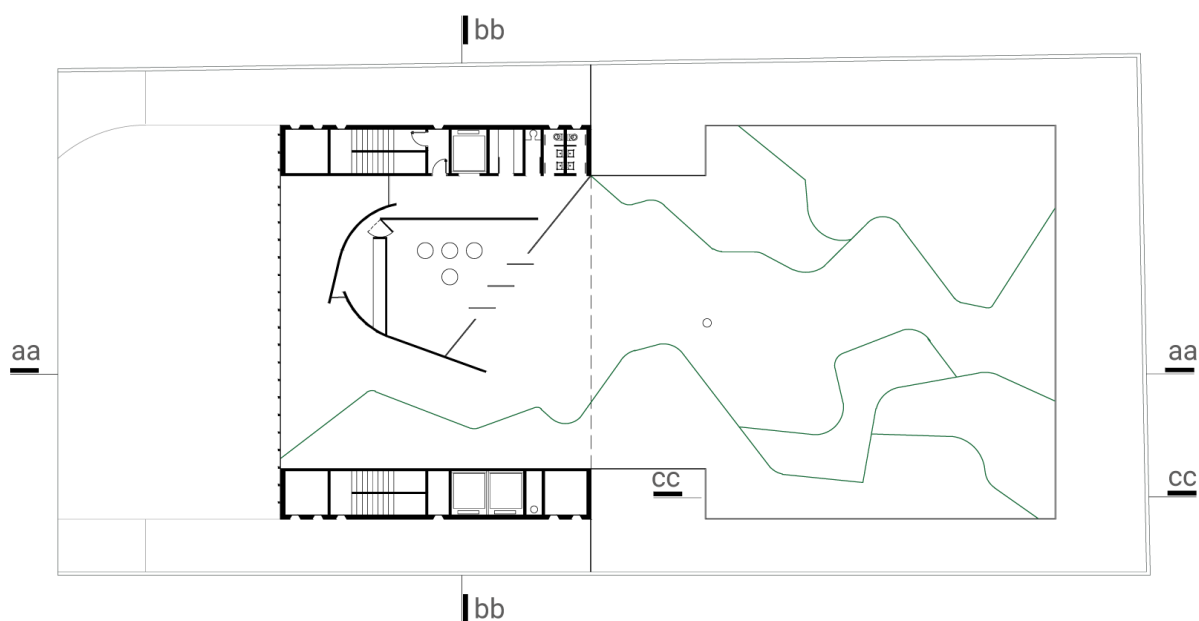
Sede para a SBPC (1978, 1º lugar): redesenho da planta térreo inferior. Fonte: autores.
